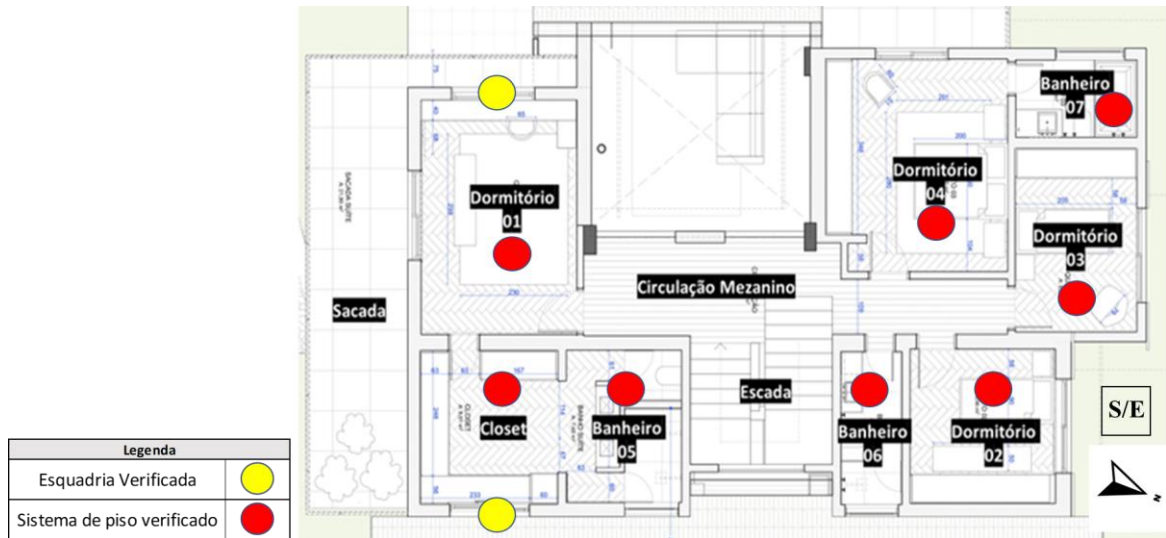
Planta baixa do pavimento térreo da edificação com destaque para esquadrias e pisos verificados
